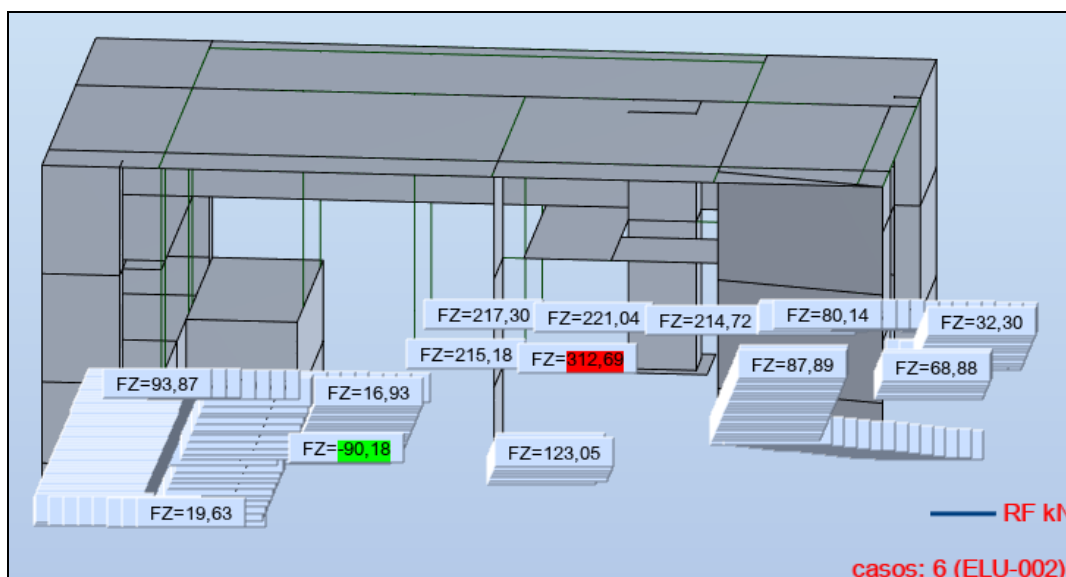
REACCIÓN AXIL EN COLUMNAS
